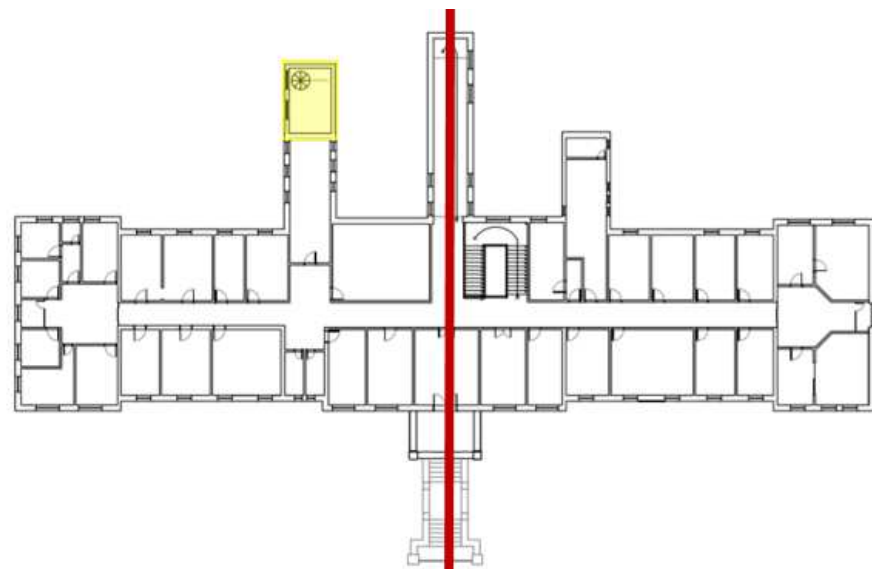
Planta do Pavimento superior com eixo de simetria. Em amarelo, um anexo construído posteriormente.
